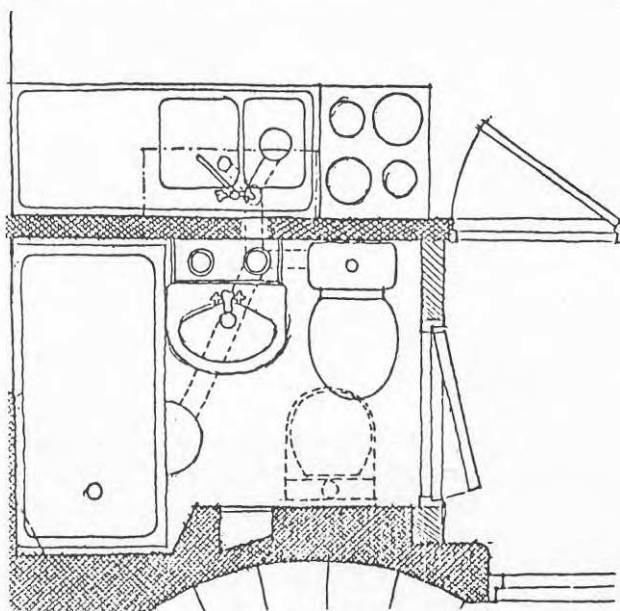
Placering av installationsblock i badrum (AB Stockholmshem, Kv Tomtebacken)
